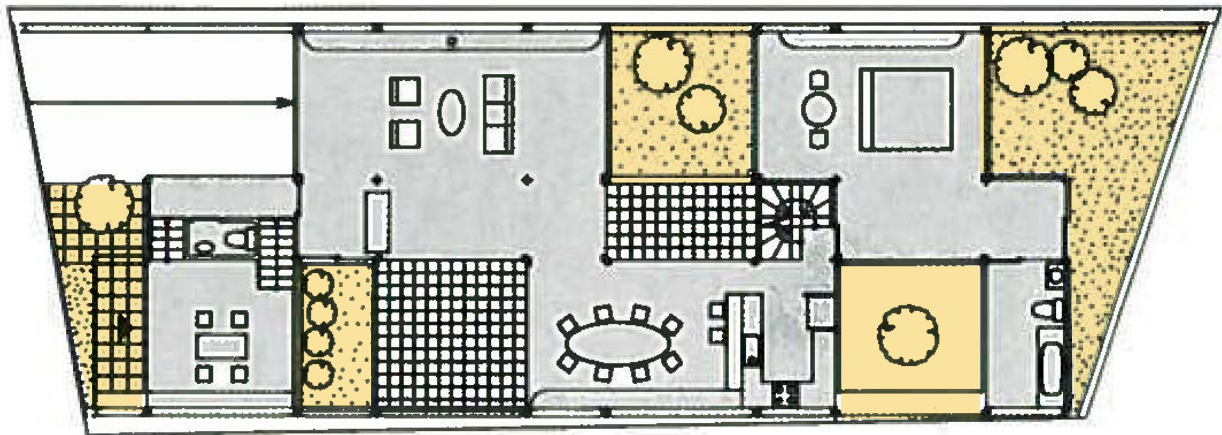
h Intégration de pièces extérieures végétalisées qui subdivisent le plan. Shigeru Ban Architects, Shutter House à Tokyo
